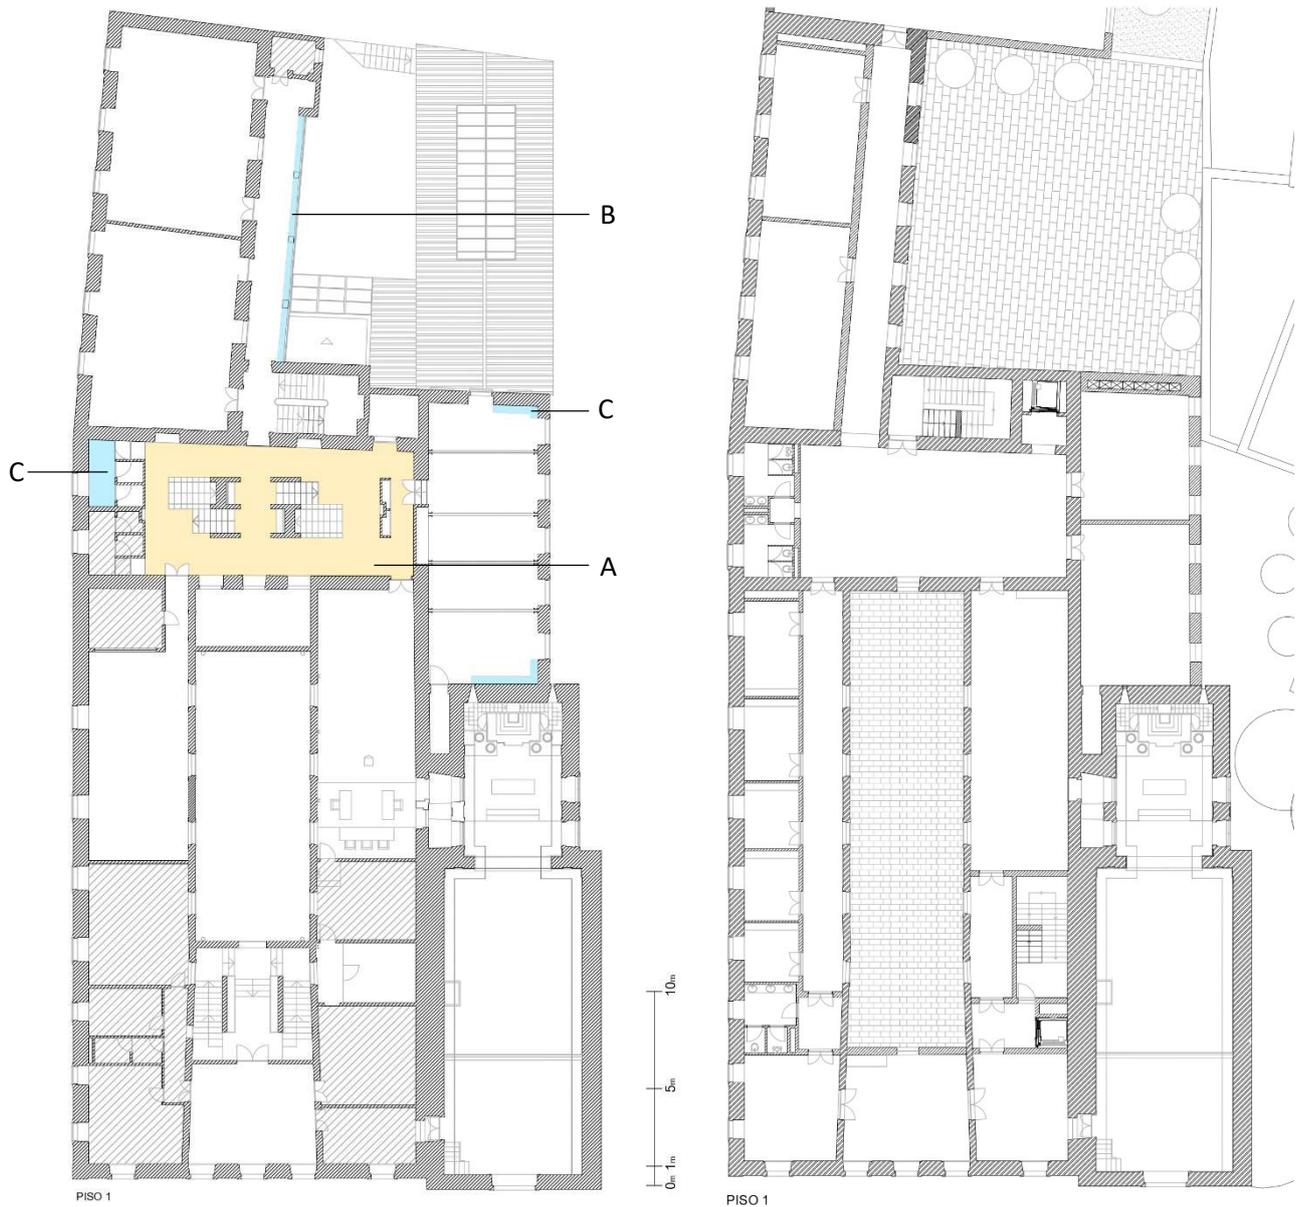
e 82 - Levantamento de patologias piso 1; Planta do piso 1 - Proposta;
